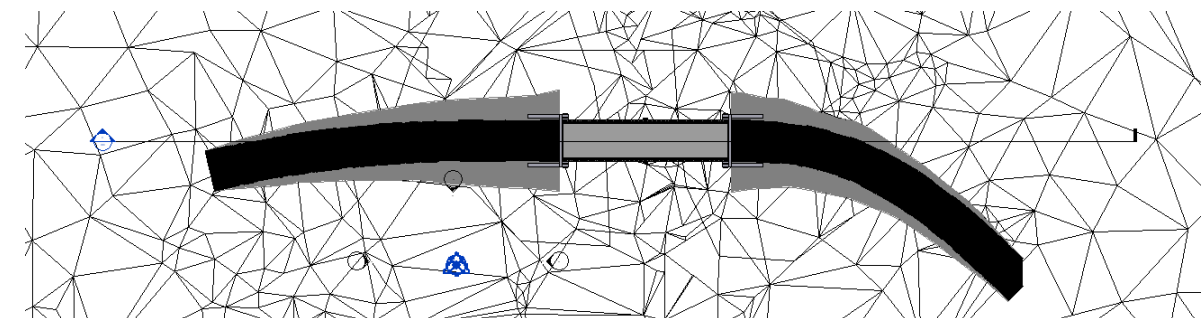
Vista en planta del modelo con sección con archivo .dwg. Elaboración propia con Revit.
